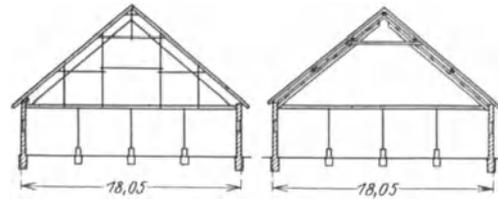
Binderformen für Dachgeschoßbauten; Zwei- und Dreigelenkbogen. Bedeutende Holzinsparung beim K.G.-Dach (Kastengitterträger), Bauweise Maerz (Vollwandträger mit Holzfasertafelsteg) u. a.
